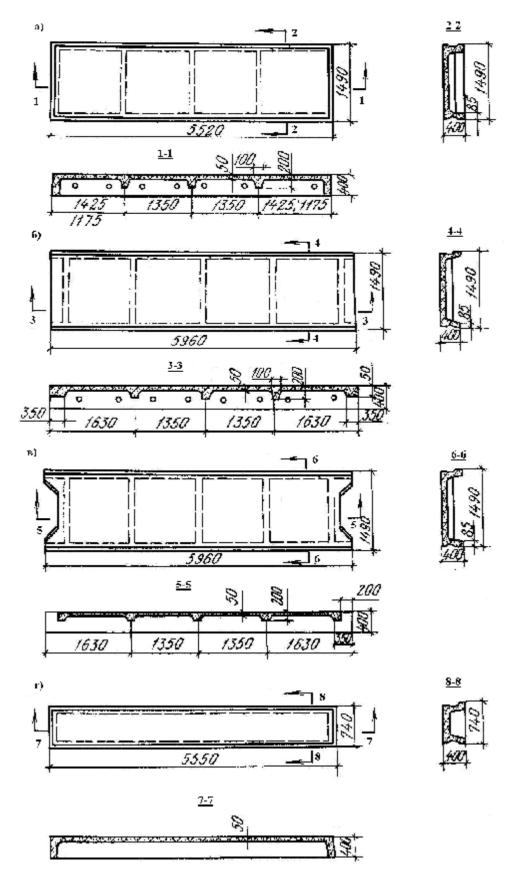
Типовые железобетонные плиты междуэтажных перекрытий производственных зданий (а – рядовой корытный настил; б – рядовой лотковый настил; в – связевый лотковый настил; г – доборный настил)
